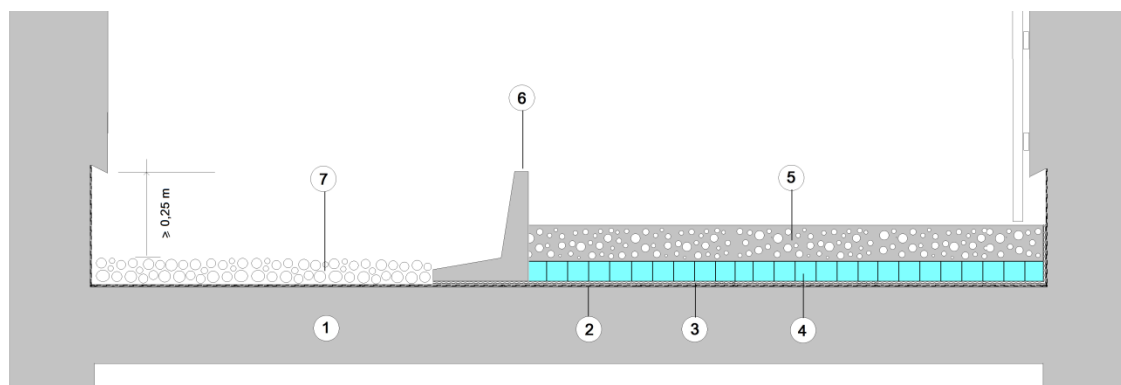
Toitures-terrasses de destinations différentes sur béton drainant Hydromédia. Exemple : jardin et piétons.
